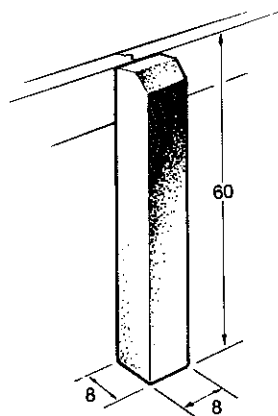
t. Steunpaaltje kantplanken ('Boot' beton).
